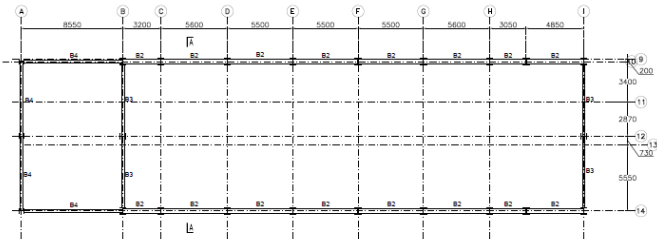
Denah atap elv. +6.45 sampai +8.75
